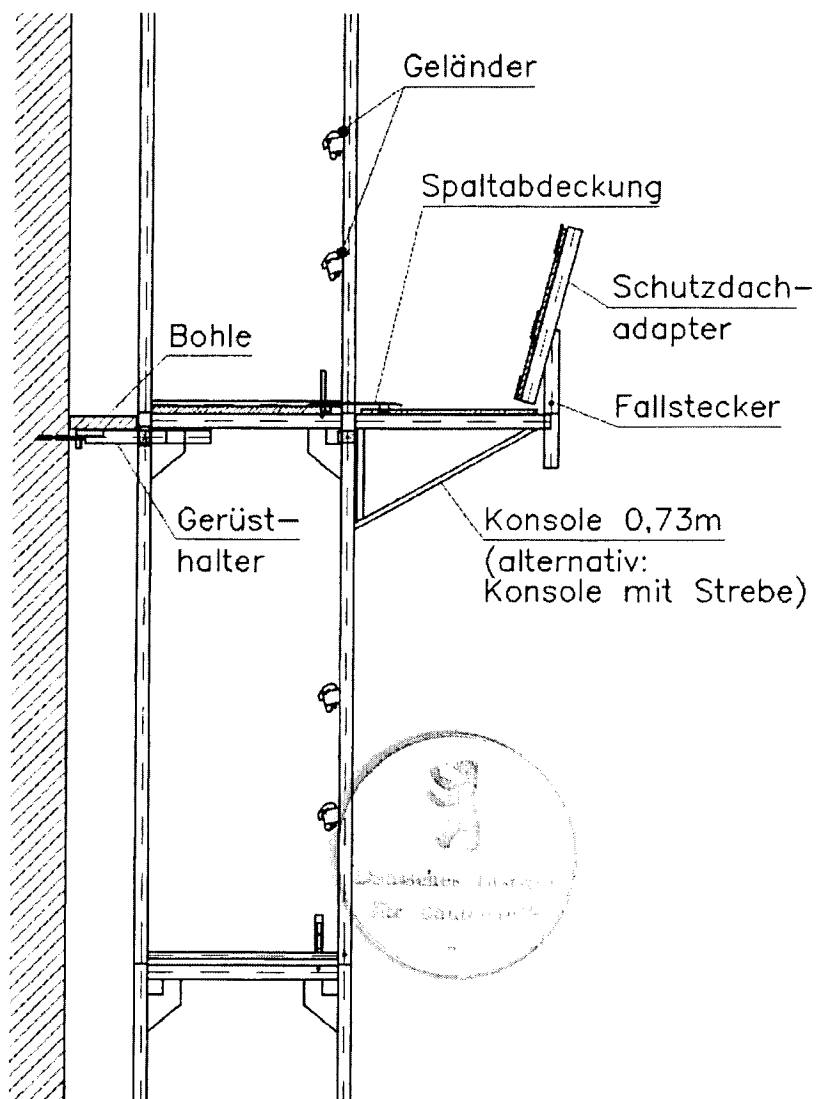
Schutzdach mit Konsolen 0.73 m und Schutzdachadaptern
